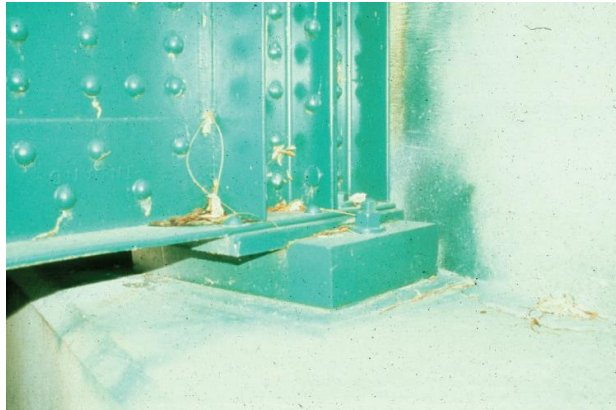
Aparelho de apoio deslizante com placas de aço lubrificadas
